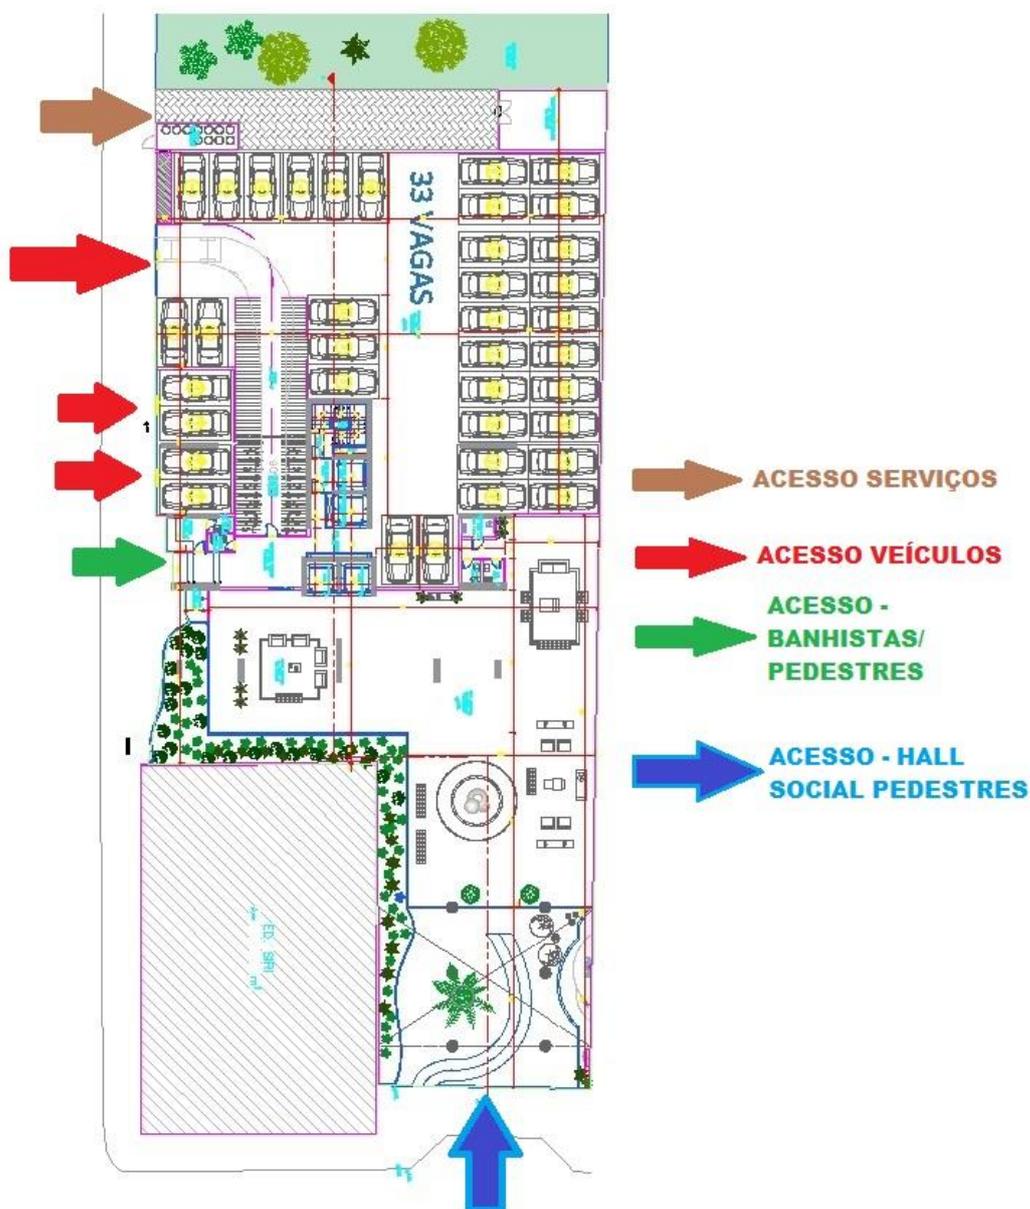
P. baixa do Pavimento Térreo apresentando as entradas de veículos e pedestres.
